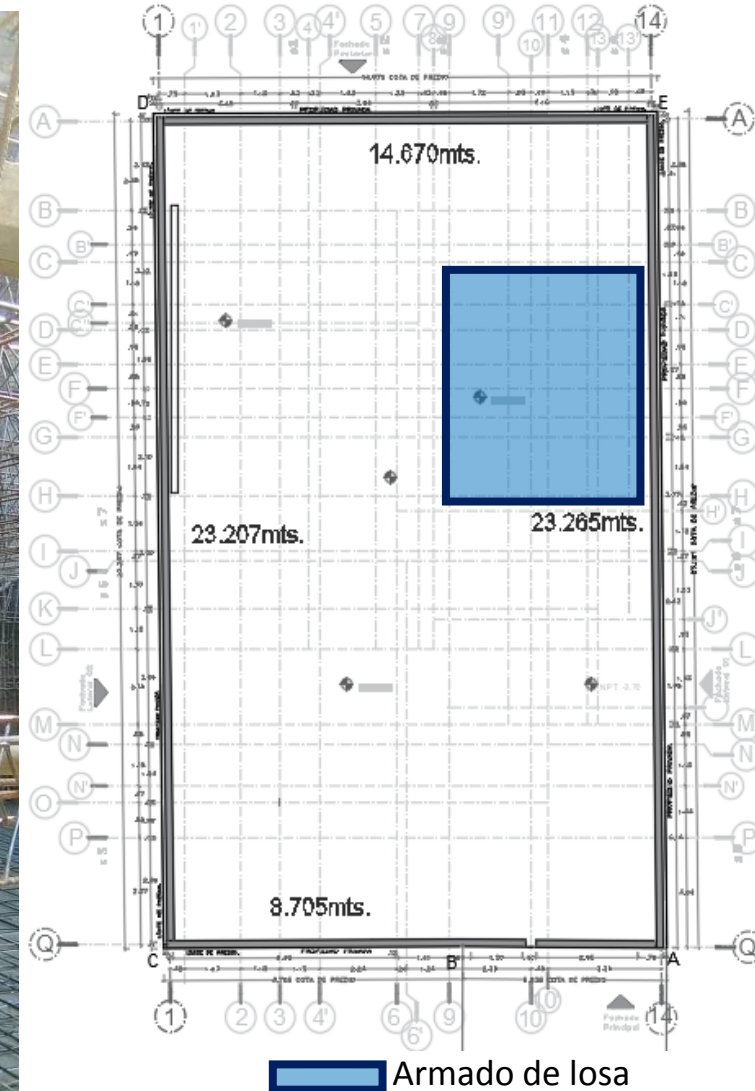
Armado de la losa sobre las CCT 9' y 14.
